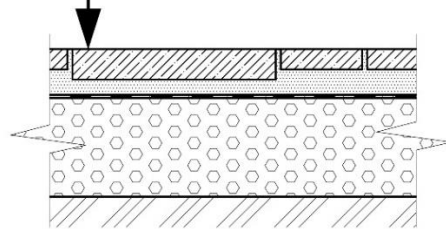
Конструкція покриття вимощення з вмонтованою тактильною попереджувальною плиткою
